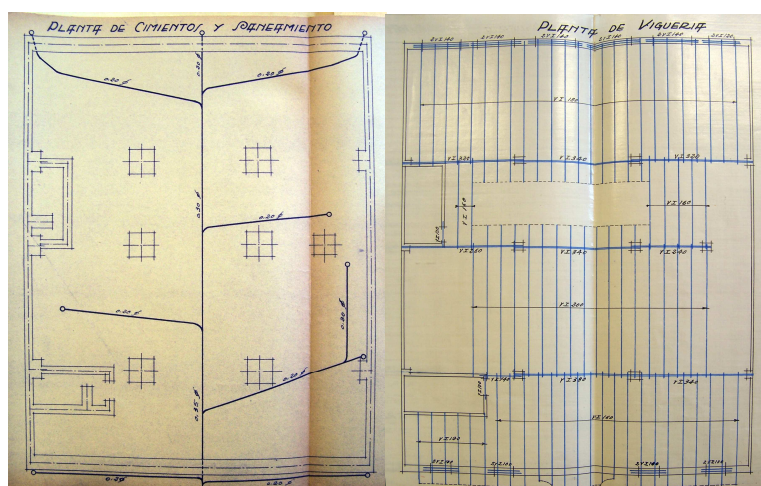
Planta cimentación y vigería del proyecto de 1934. Archivo Histórico Municipal.
